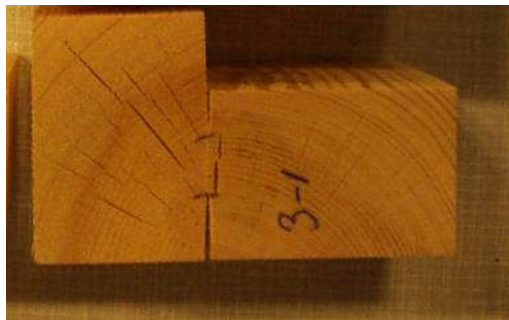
Den stående lamellen betecknas högbit och den liggande lamellen betecknas lågbit.
